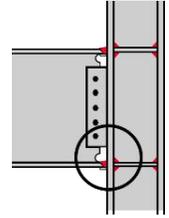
Ejemplos de daños en las uniones viga-columna de pórticos de acero.
